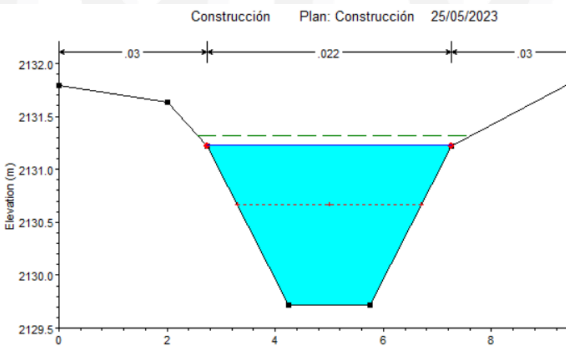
Sección típica del canal provisional para el desvío durante el proceso constructivo de los Box Culvert N°1, 2, 3 y 4 (aguas abajo)
